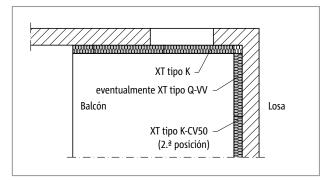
Schöck Isokorb® XT tipo K, Q- VV: Balcón en esquina interna, apoyado sobre dos laterales
